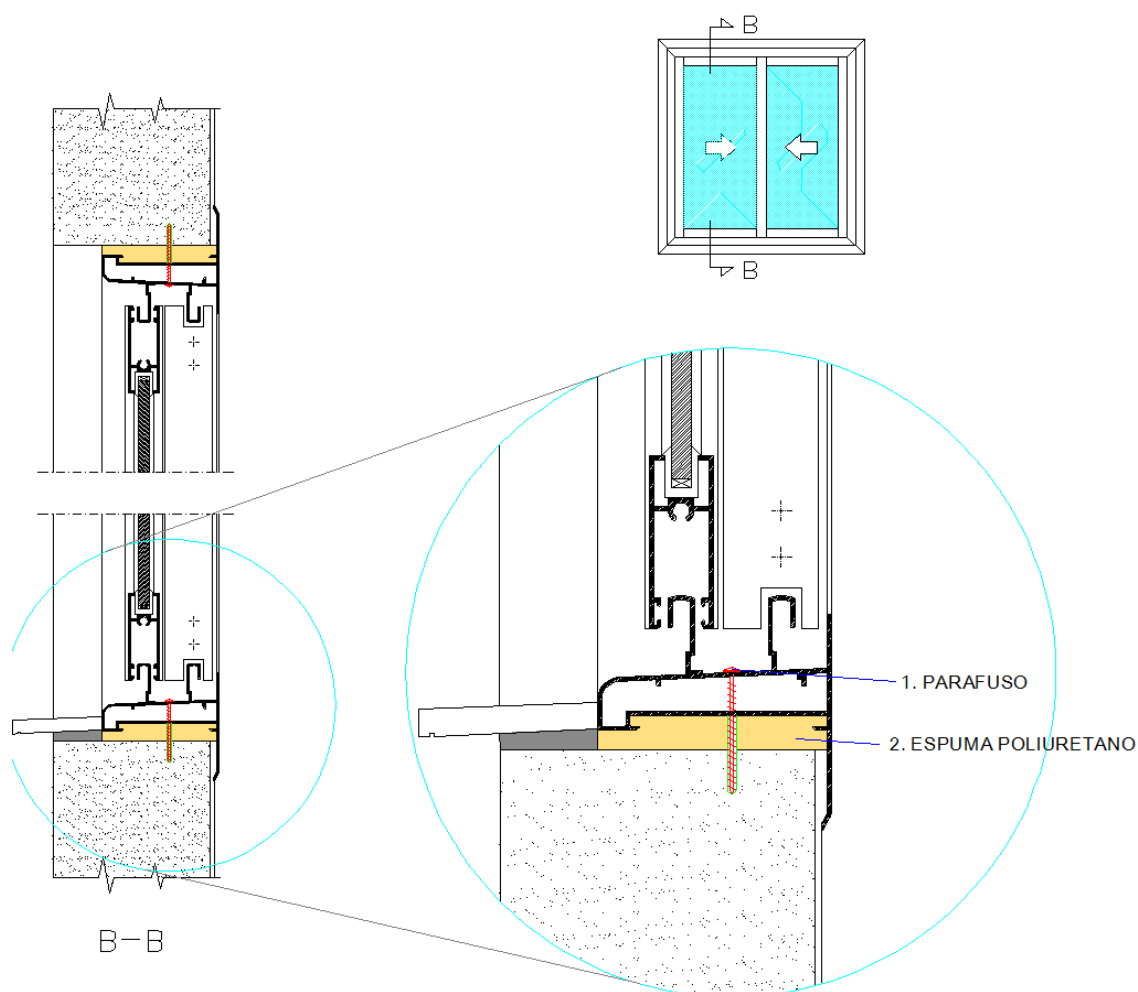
Detalhe da interface entre o painel e a janela na fachada (sem escala)
